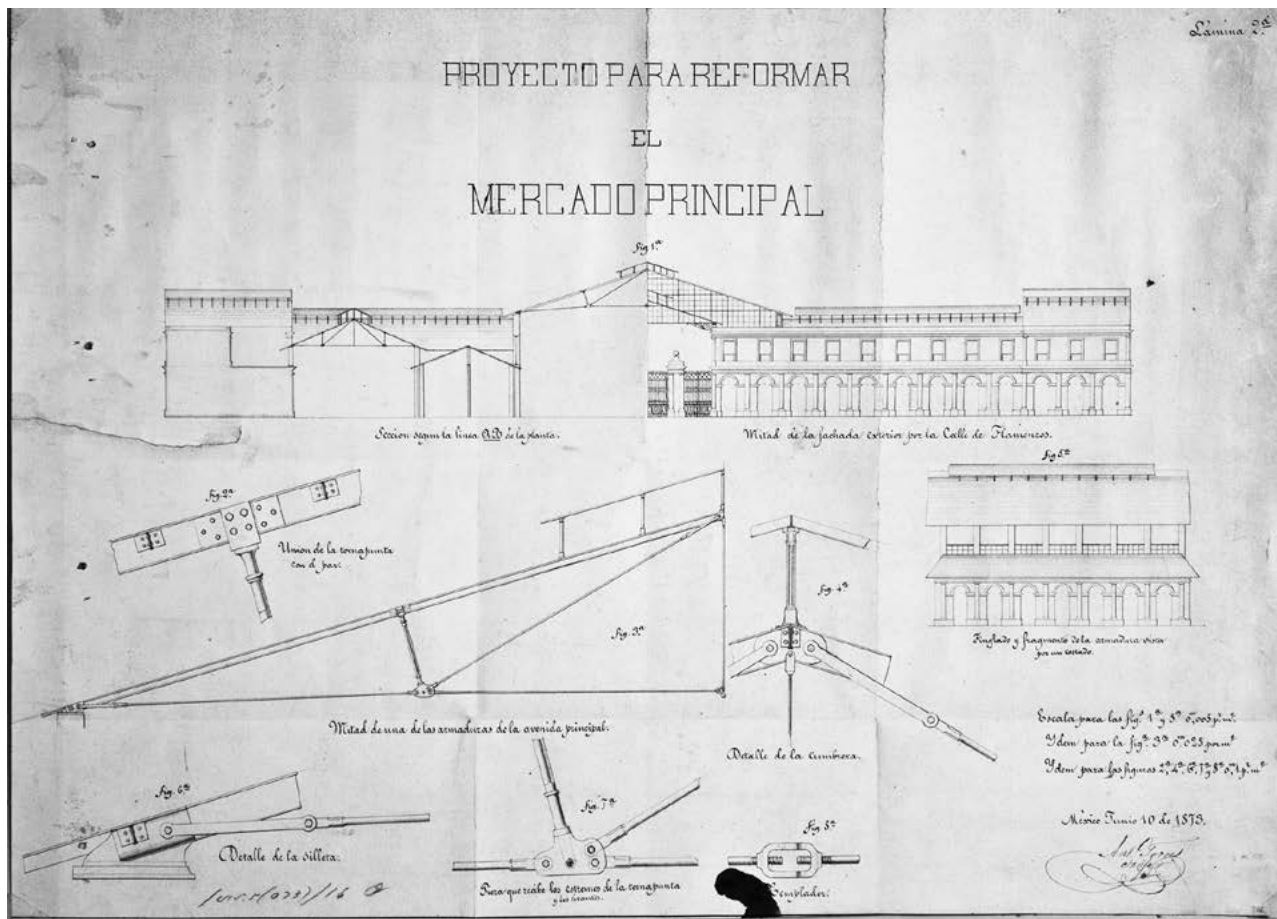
Proyecto para reformar el Mercado Principal; fachada, corte y detalles constructivos, arquitecto Antonio Torres Torija, 1873. AHDF, Planoteca, planero 1, módulo 3, fajilla 41. Fotografía de Roberta Vassallo.
